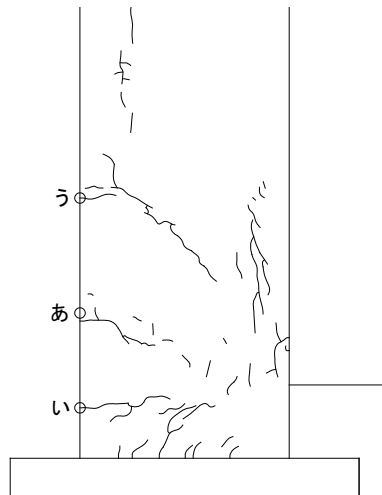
柱ひび割れ幅測定位置 (試験体 A-7b 正載荷)
